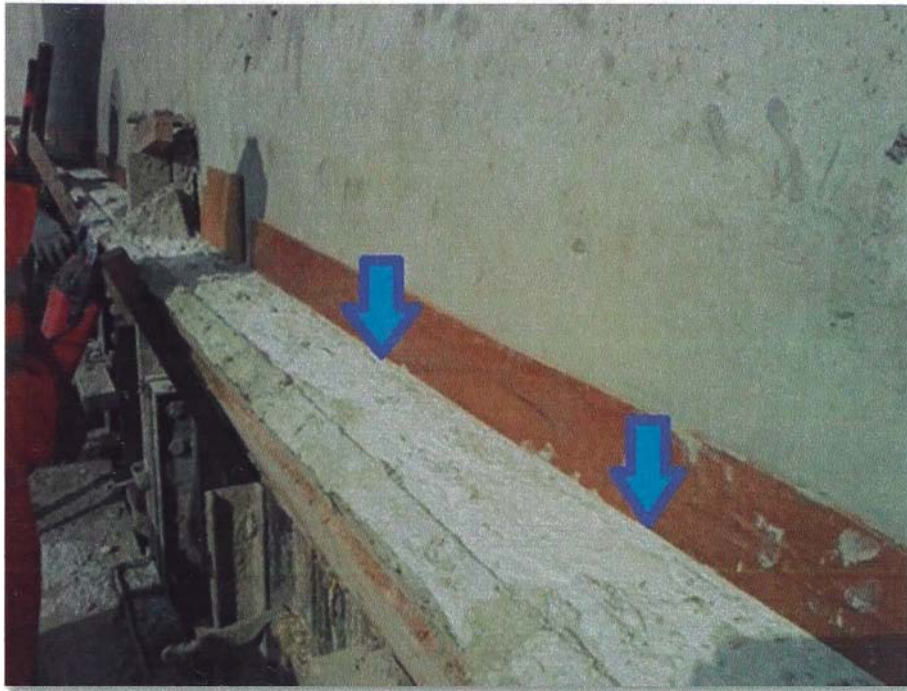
Plancha de fenólico que separa a la cachimba del muro
